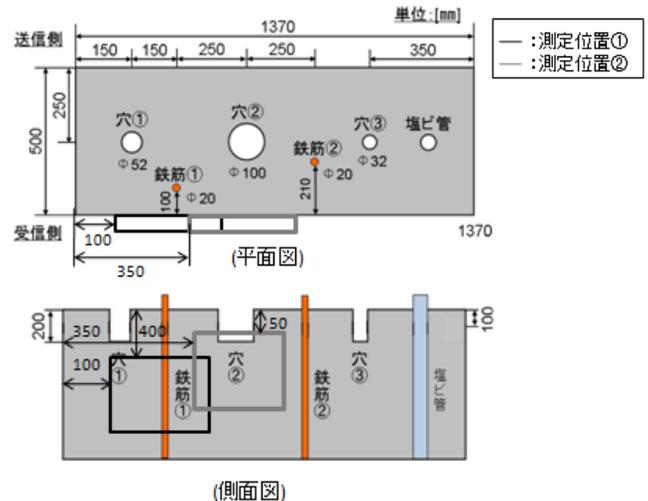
異物の混入したモデルコンクリートブロックの平面図及び側面図
